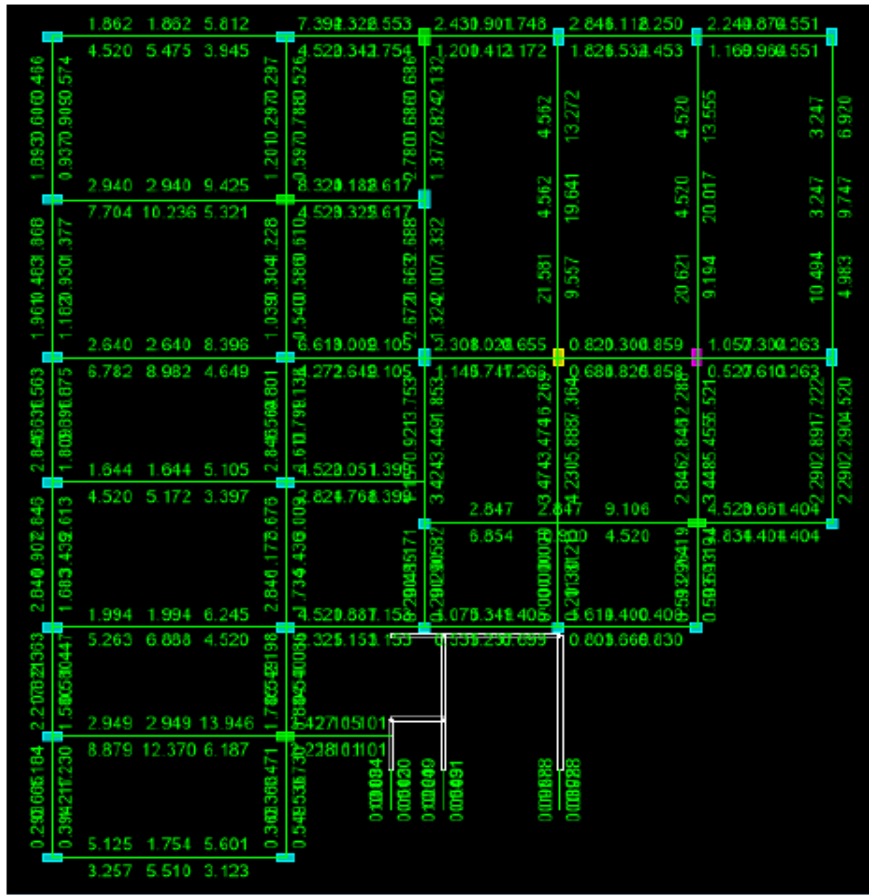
Área de acero de refuerzo en vigas Segundo Techo (cm²)
